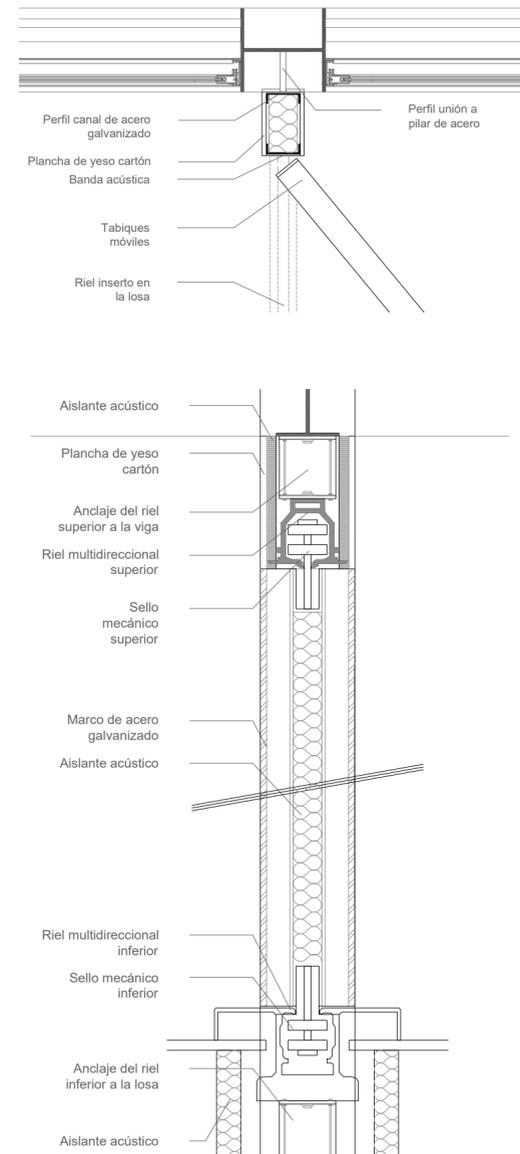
Planta y corte del tabique móvil interior. Fuente: Elaboración propia
